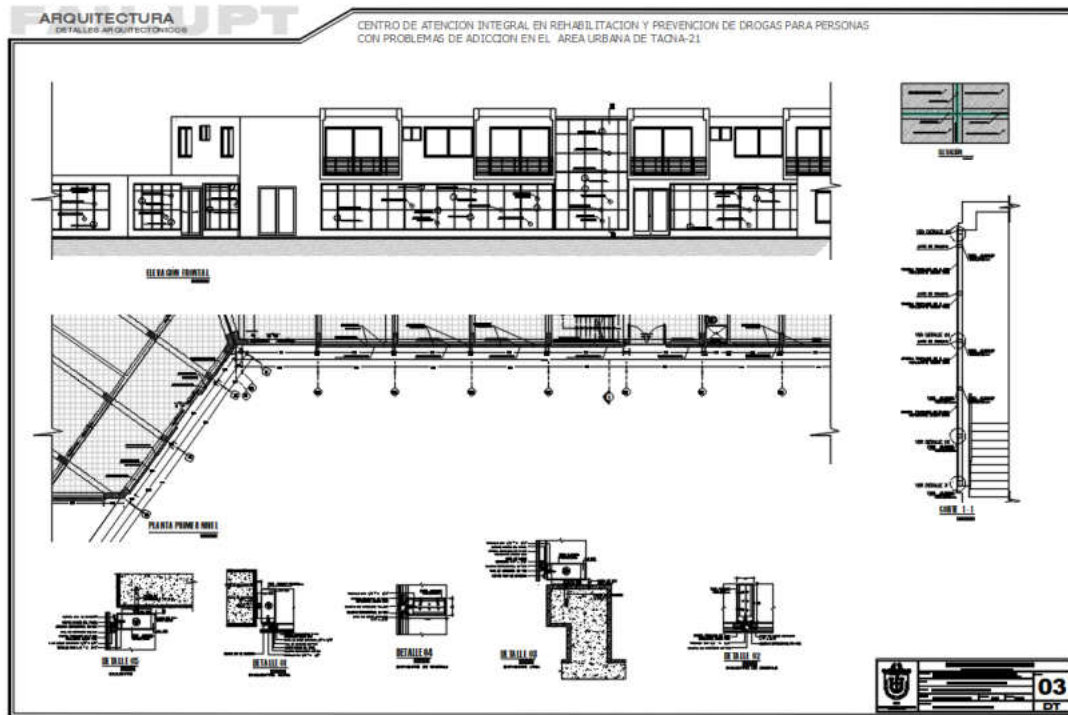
, detalles arquitectónicos-M. cortina, fuente elaboración propia
